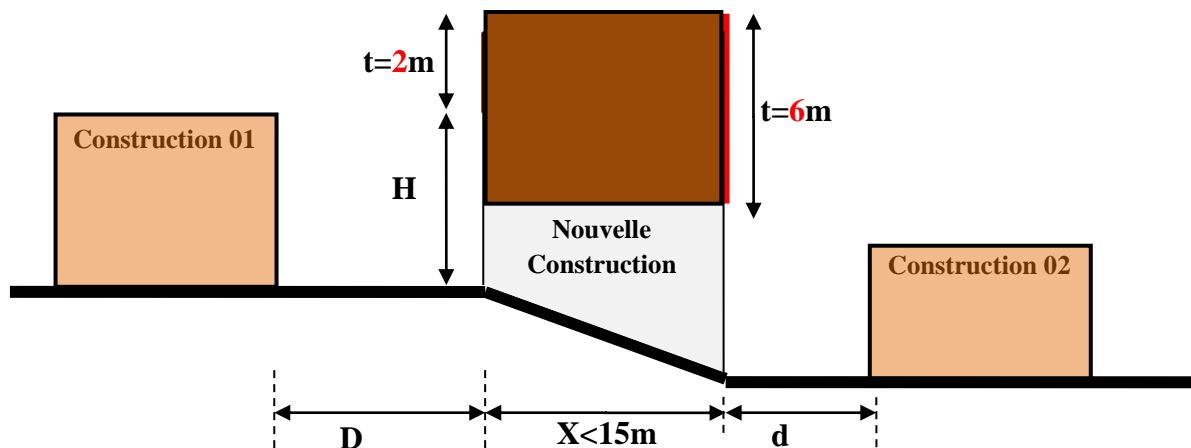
Coupe définissant la hauteur d'une construction localisée entre 02 voies d'inégales largeurs (voies sur des niveaux différents).
